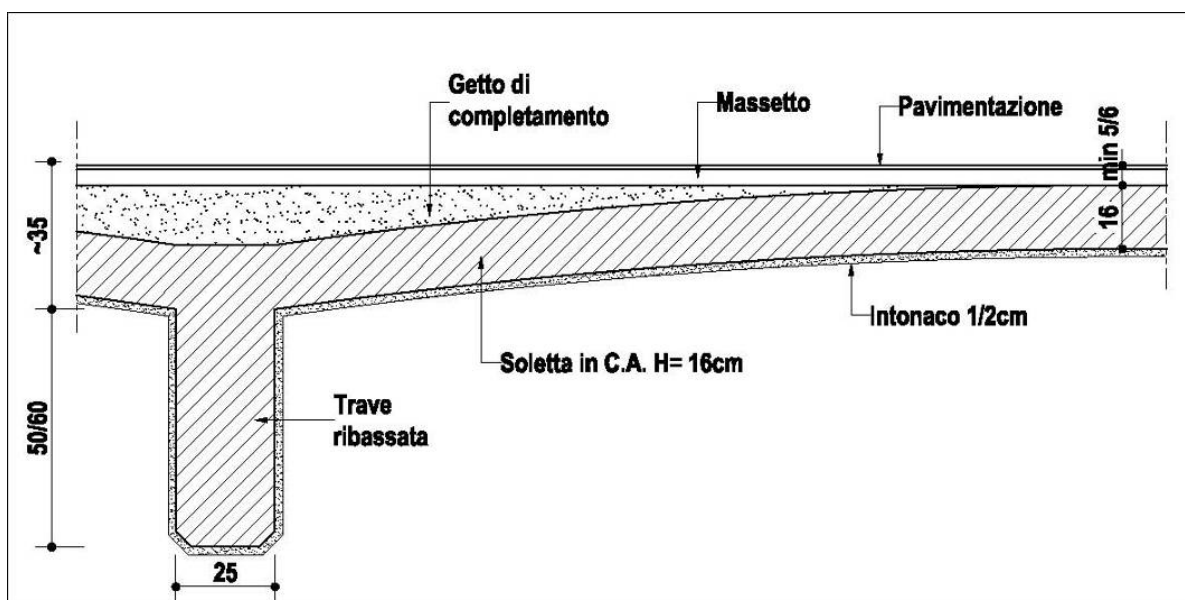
Solaio P. Rialzato – Torretta nord-ovest – Trave ribassata in c.a.
